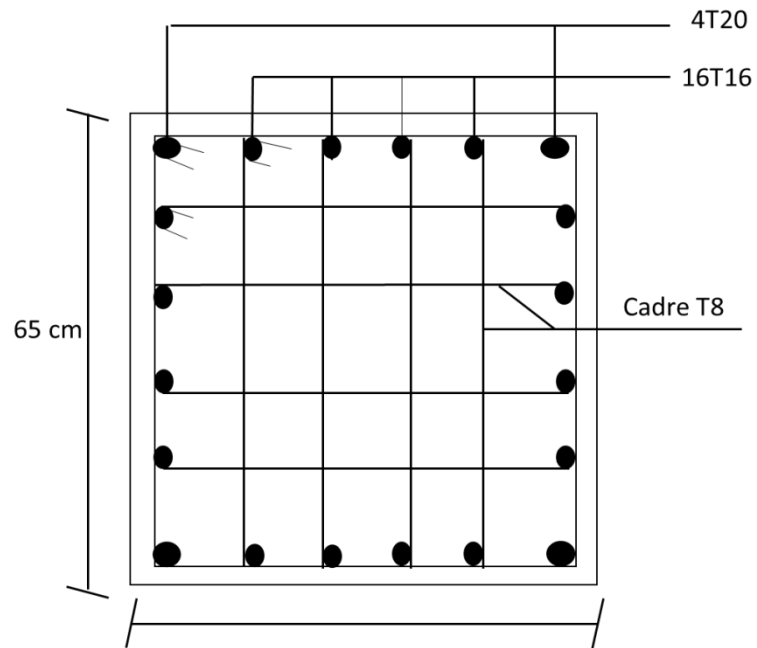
schéma du ferrailage Poteau 2^{eme} et 1^{er} étage.
